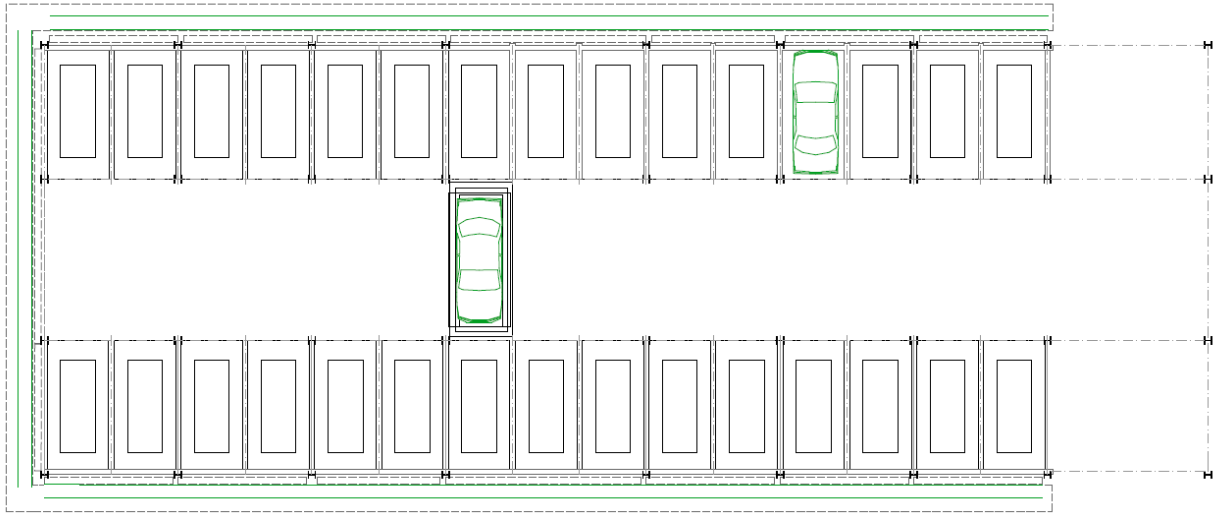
layout furniture interior ground floor (sumber: analisa penulis)
